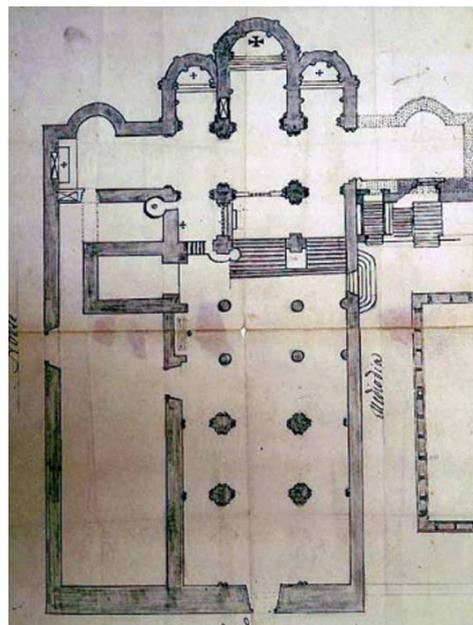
Plano atribuido a Rodrigo Echevarría (Siglo XVIII)
